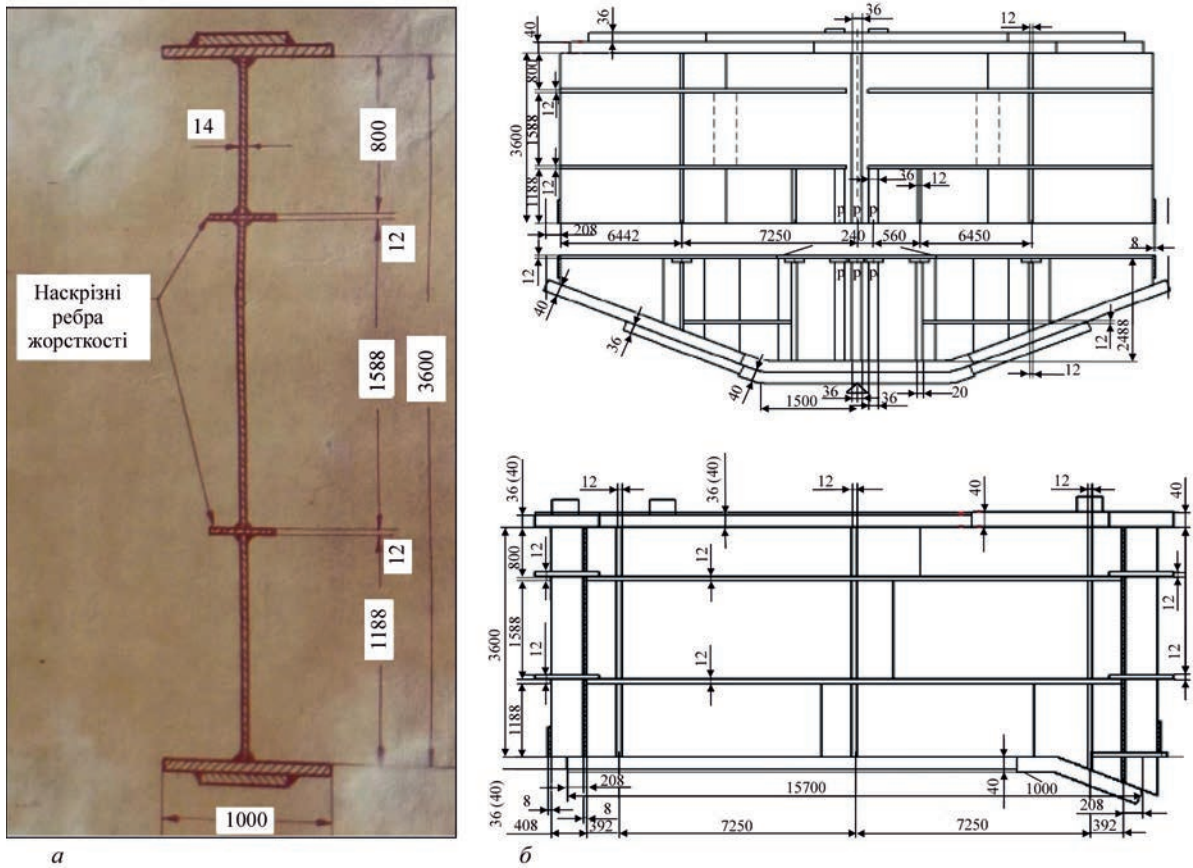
Поперечний переріз головної поздовжньої балки двотаврової перетину (а) і креслення фрагментів головної поздовжньої двотаврової балки (б)
